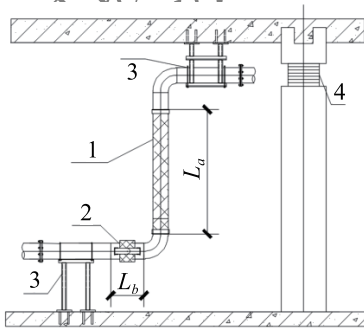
压力管道隔震柔性连接竖向构造示意图 b
